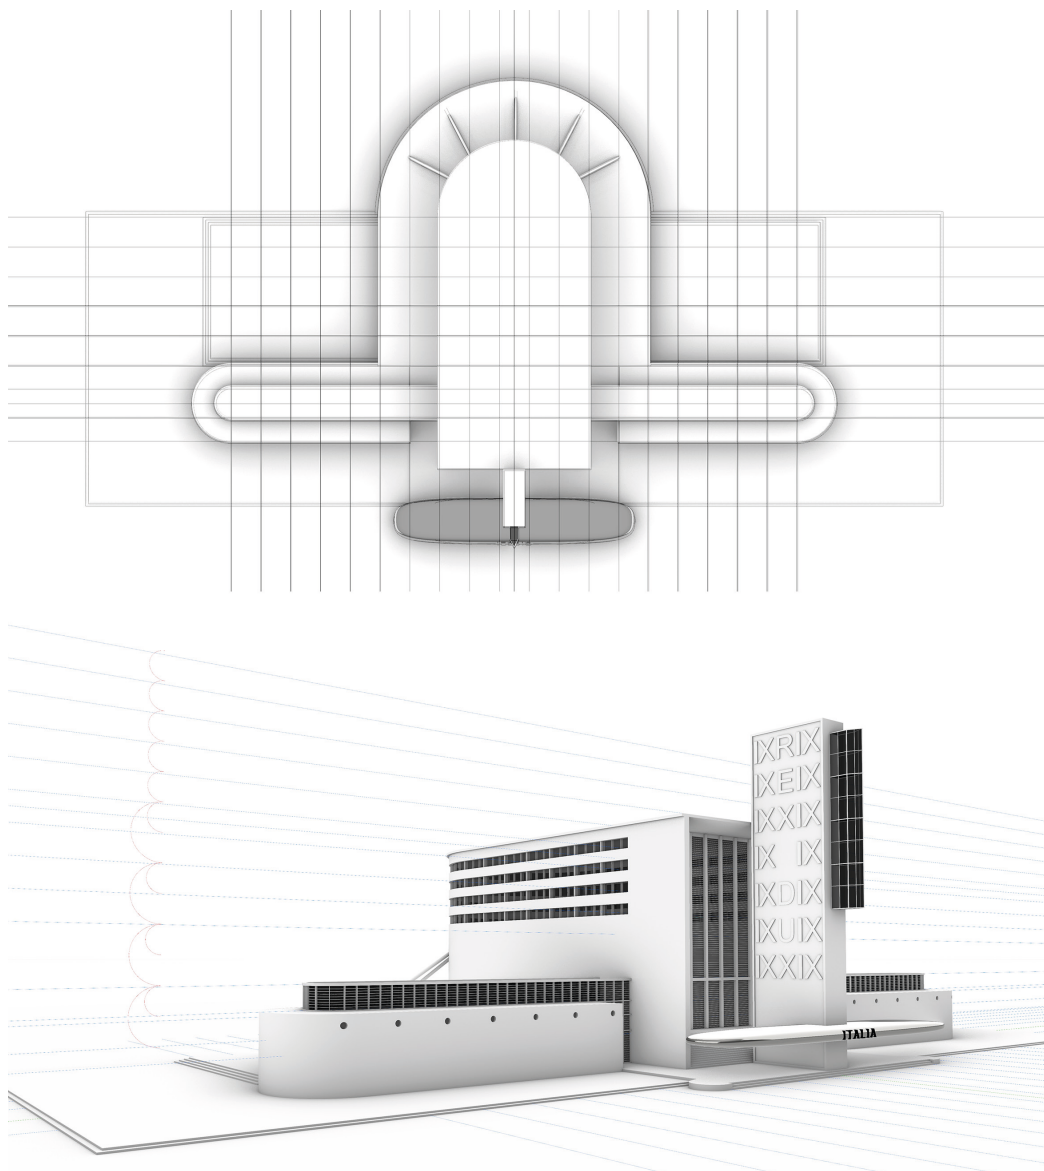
Pianta renderizzata con individuazione degli assi principali e secondari. In basso, prospettiva con i moduli sviluppati in altezza (elaborazione dell'autrice).
